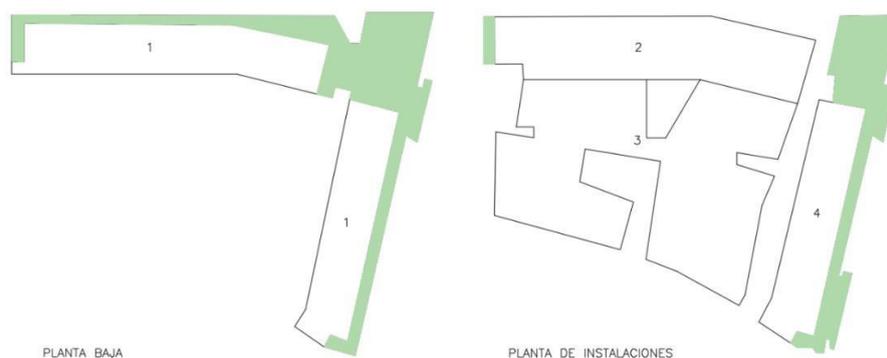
Distribución de zonas de “Viviendas Can Travi”
